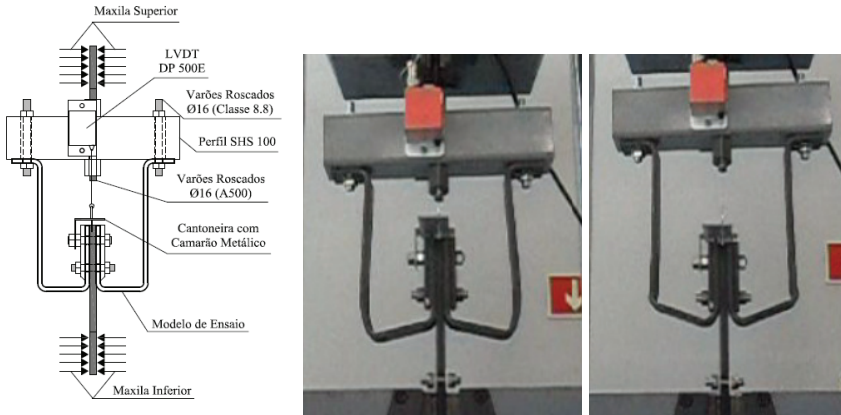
Esquema do ensaio do dispositivo de ligação apenas. Vista das deformadas dos dispositivos DR 70x10-2 durante o ensaio.
